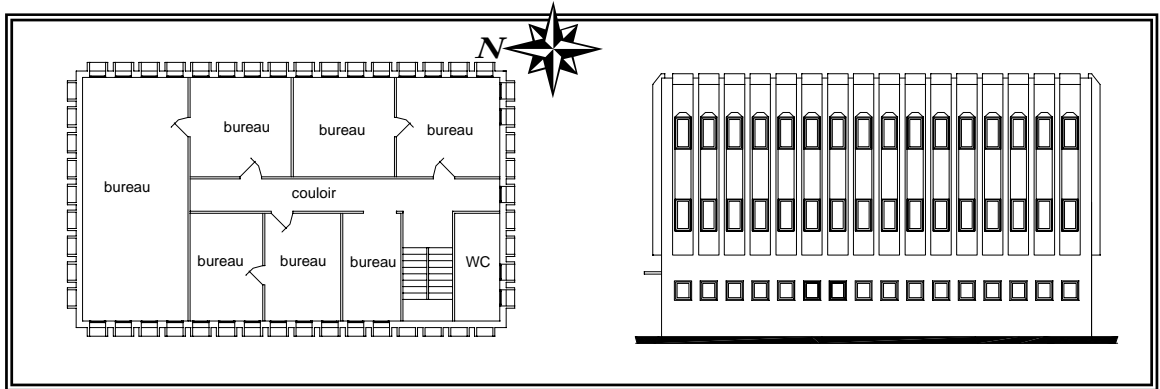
rectorat, le plan du 2e étage et la façade est
